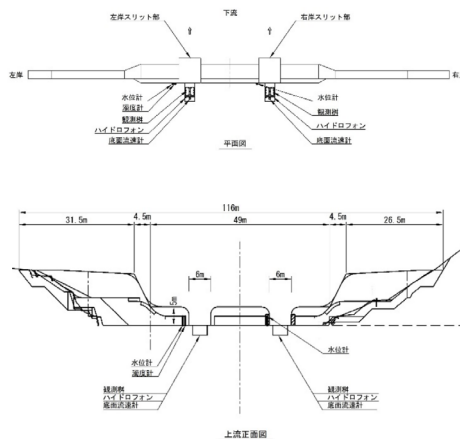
瀬戸砂防堰堤平面図(上)および正面図(下)
